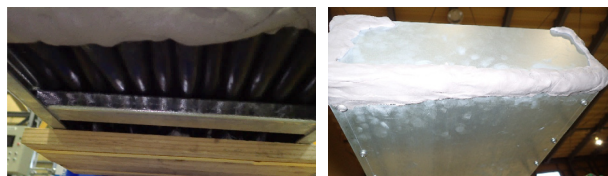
底面当て板施工状況(左: 施工前 右: 施工後)
